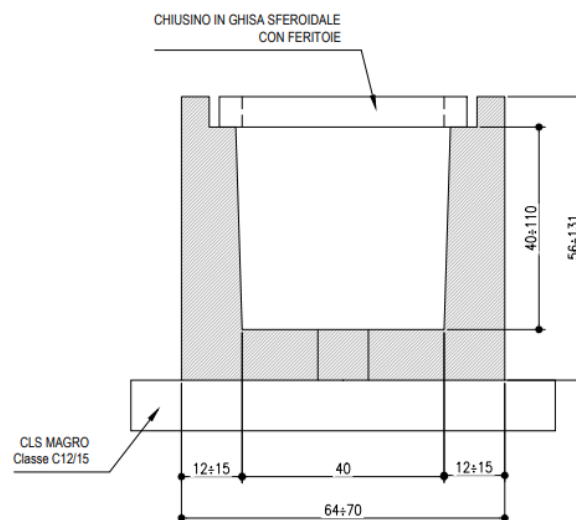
Sezione tipologica della canaletta rettangolare in cls
